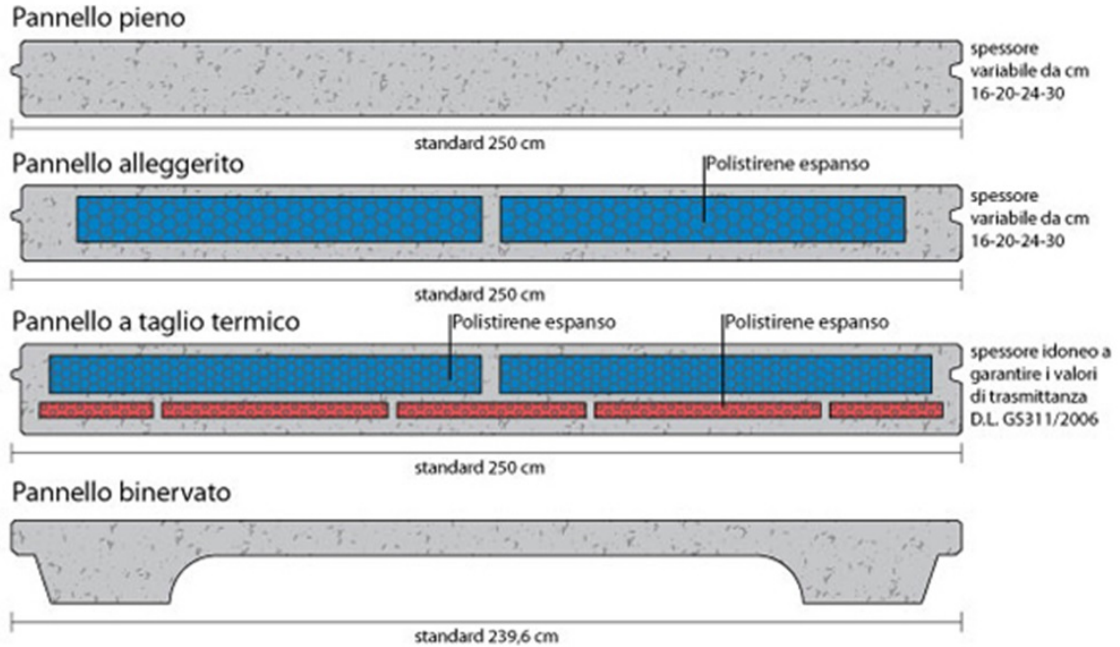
Sezioni pannelli di tamponamento esterno.
